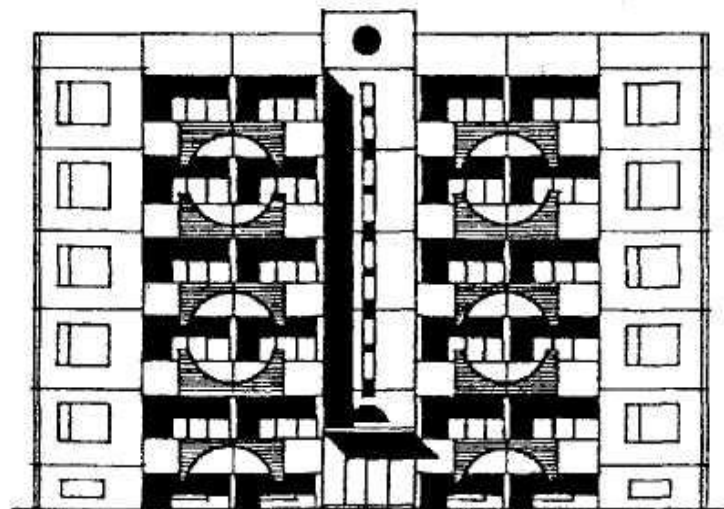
Примеры выполнения фасадов жилых домов из крупноразмерных элементов
